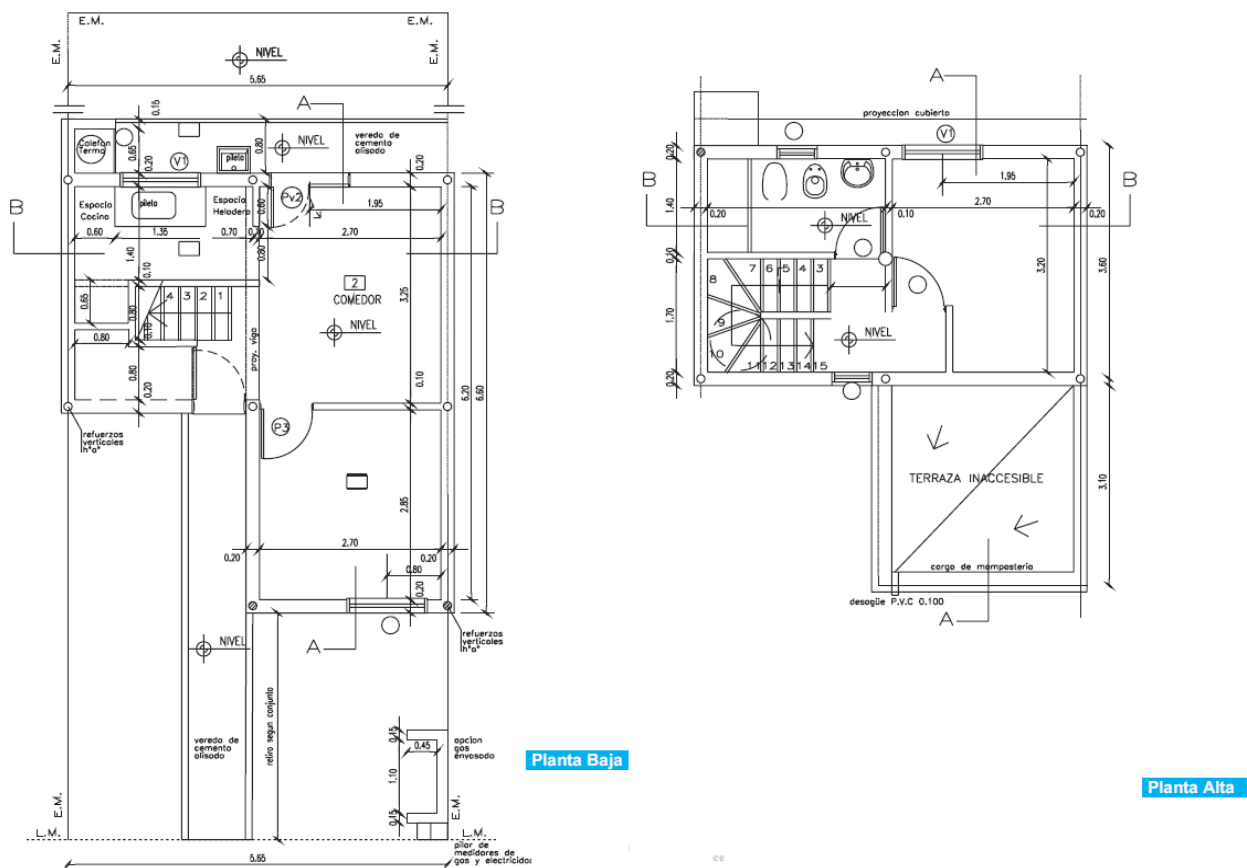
Planos Plan Federal de Vivienda, tipología Dúplex. Fuente: Instructivo Plan Federal de Viviendas.¹⁷
